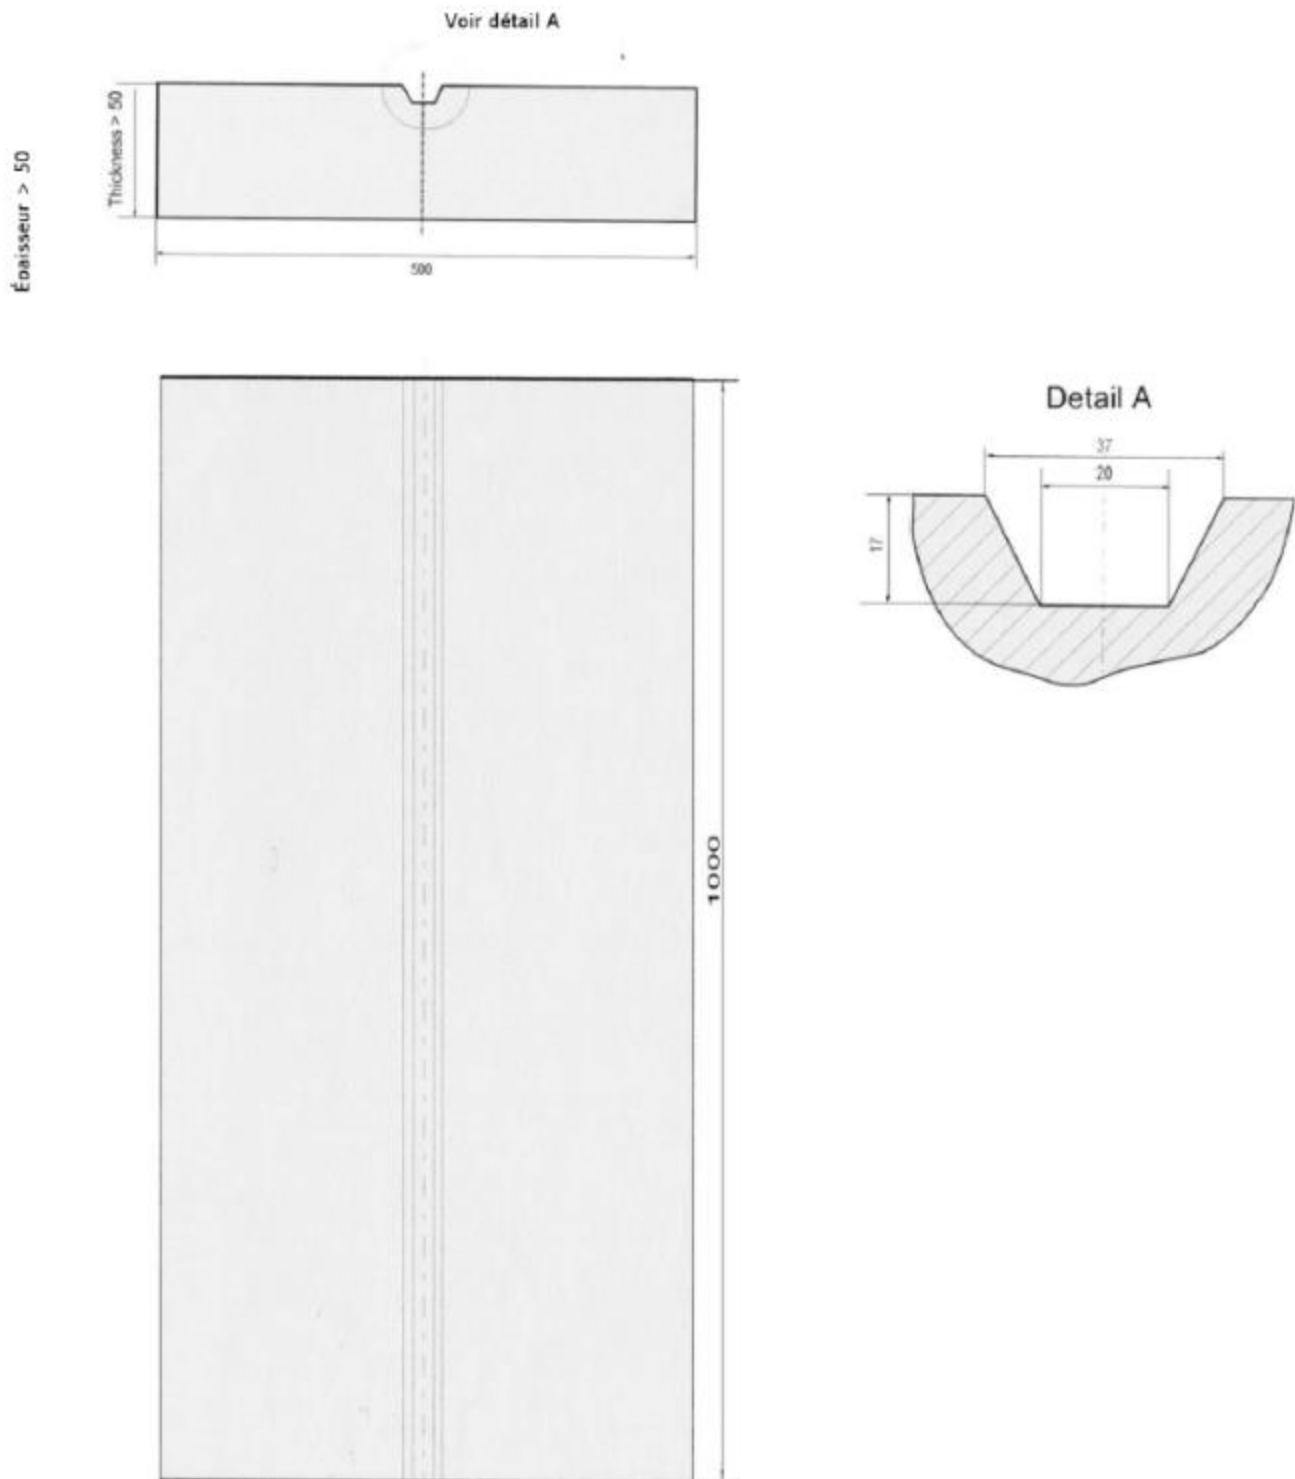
Sto-Panneaux pour Bossage Type II (dimensions en mm)
